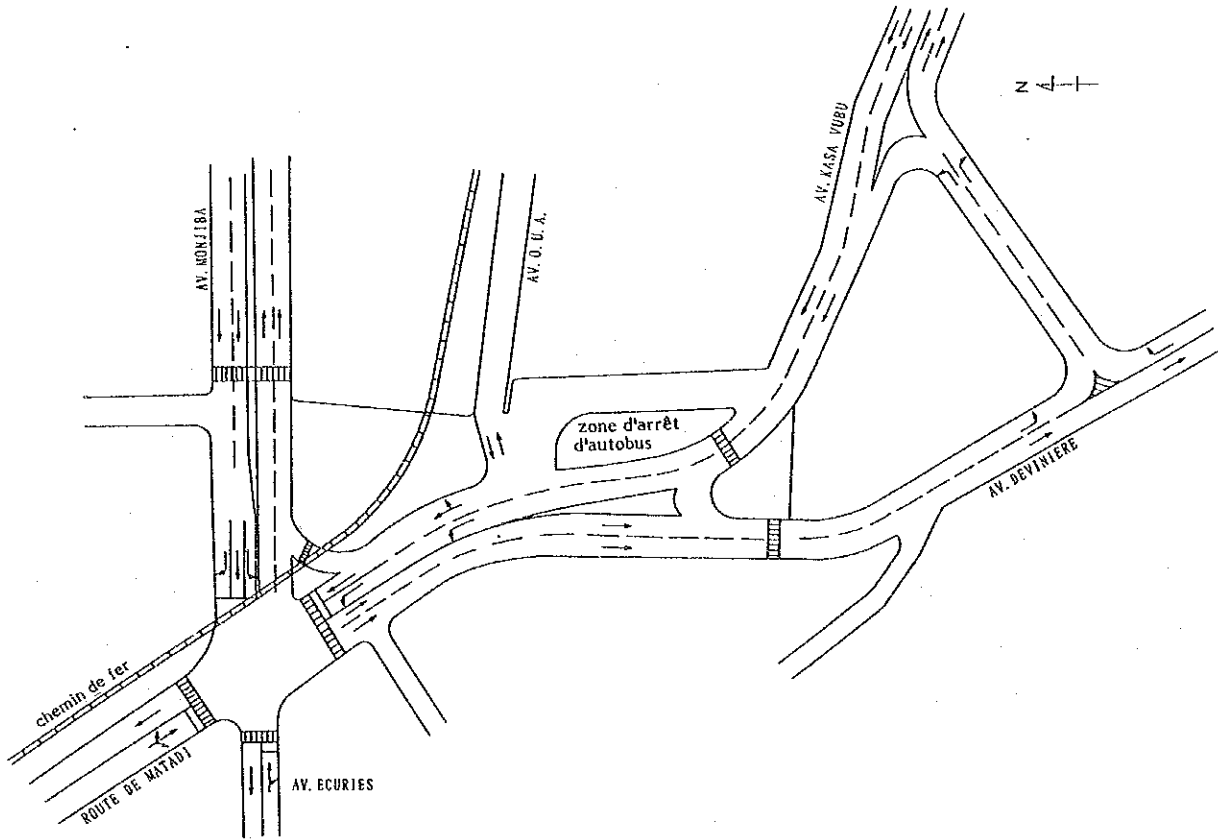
Plan d'aménagement du carrefour de KINTAMBO 2015 (Cas-2)
